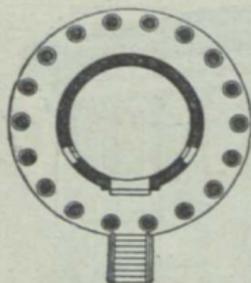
Grundriss des Besta-Tempels zu Tivoli.
